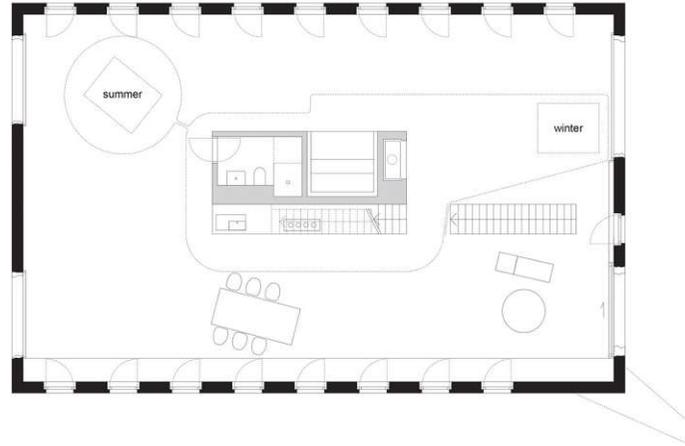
Antivilla | Grundriss Obergeschoss
